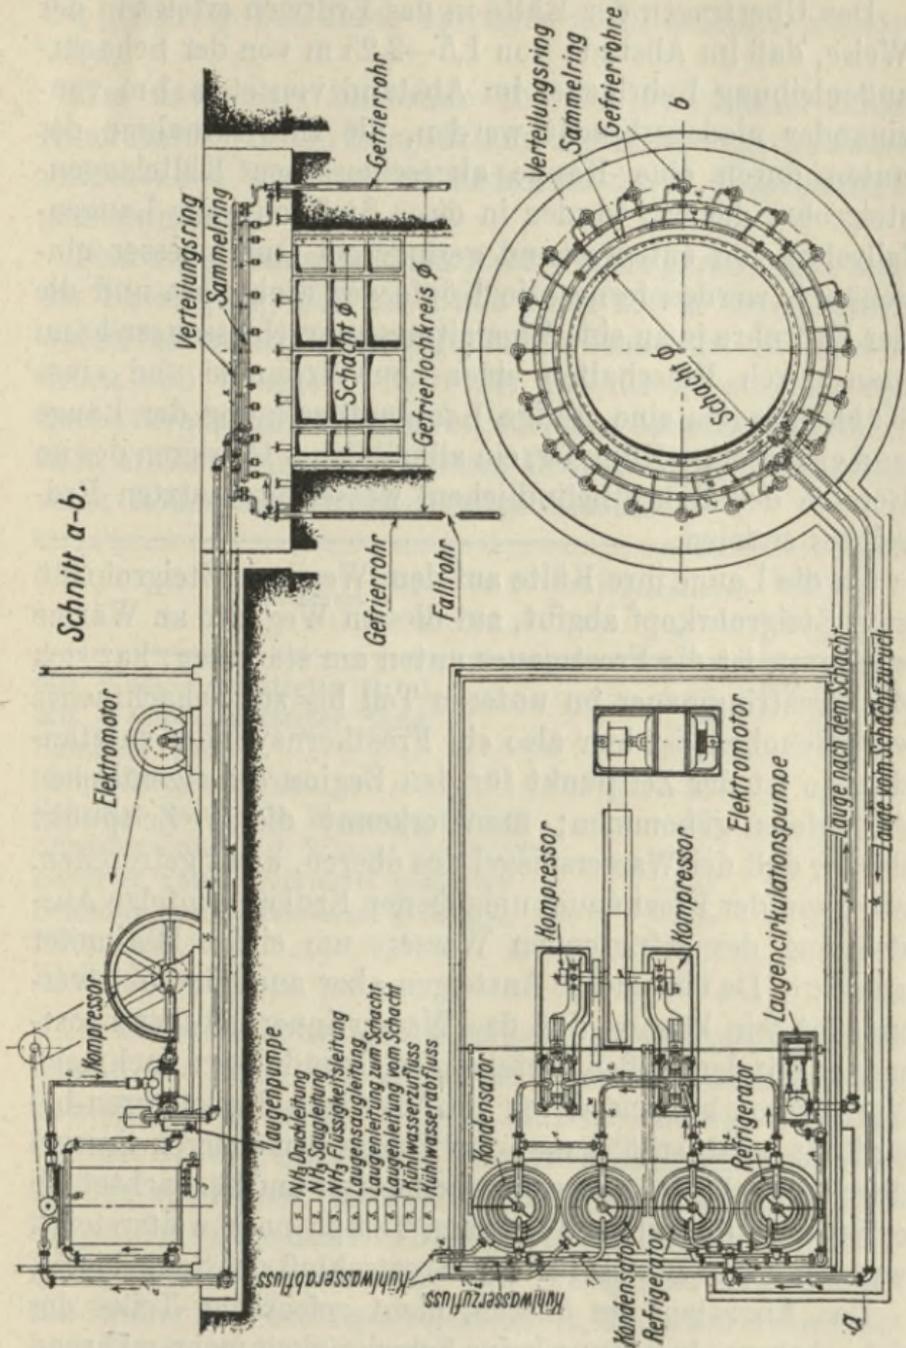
Grundriß und Aufriß an der Gefrierschachanlage der Tiefbau- und Kälteindustrie A. G.
